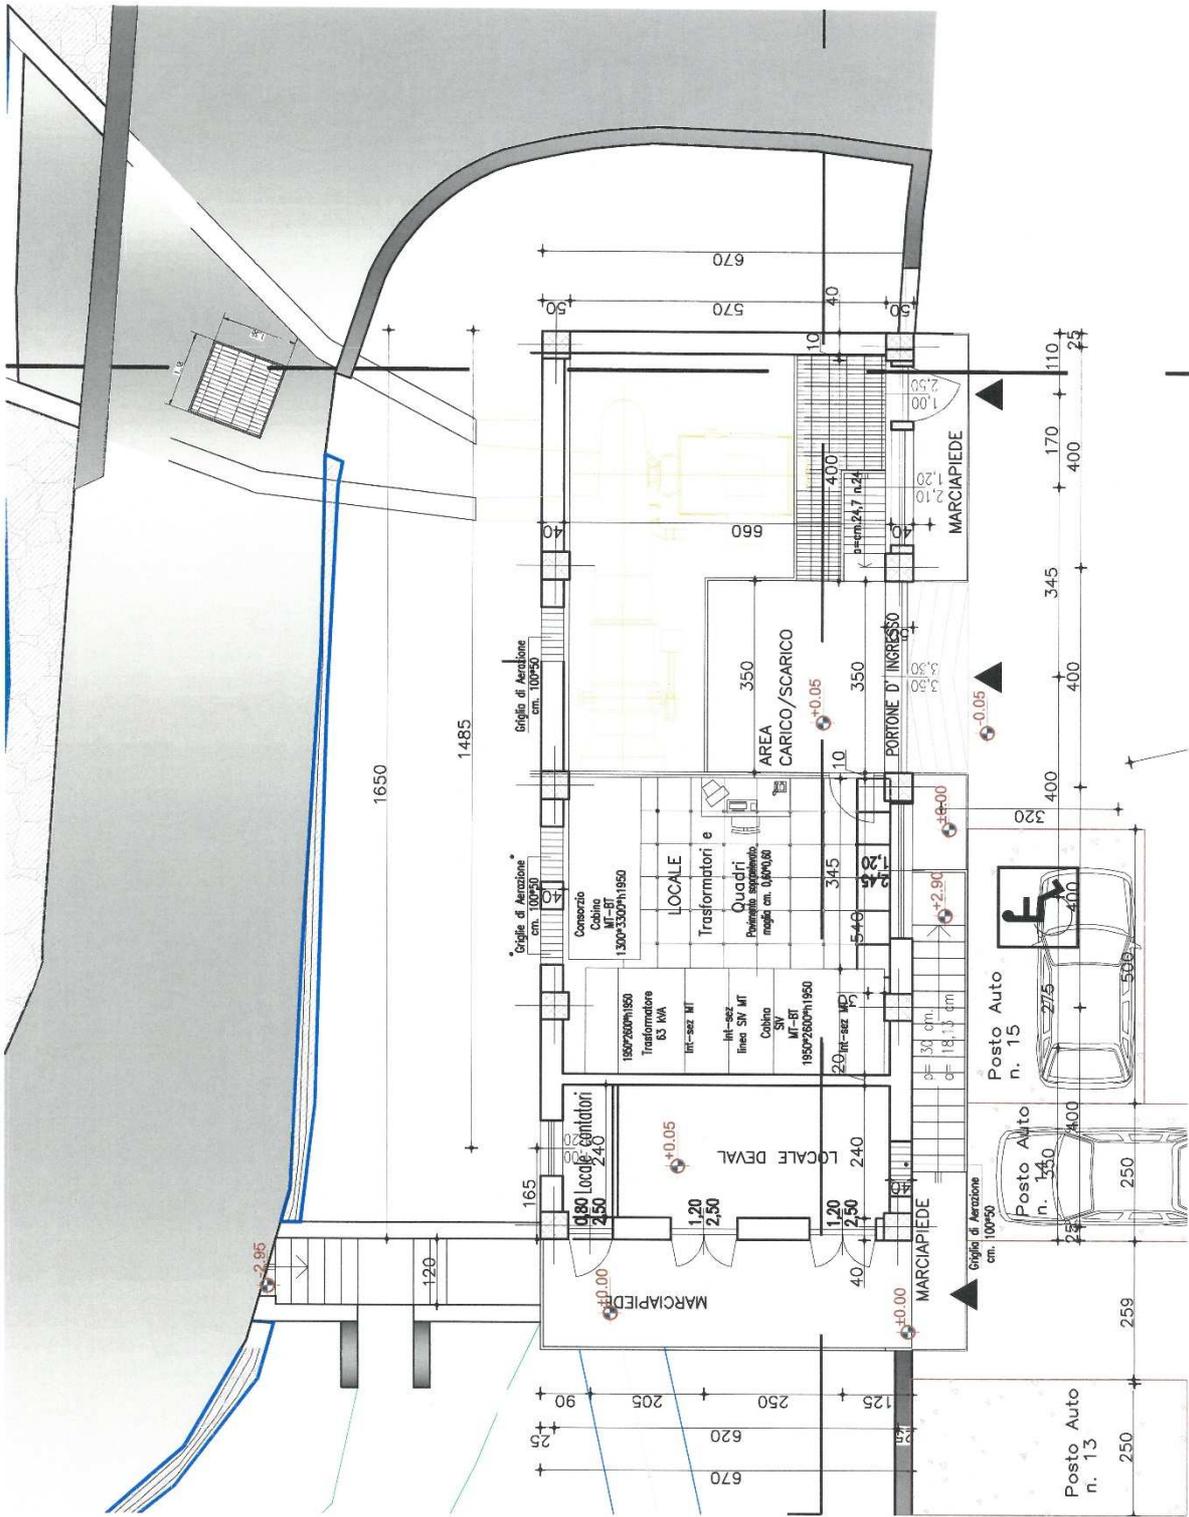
Pianta piano terra fabbricato centrale nel progetto autorizzato
